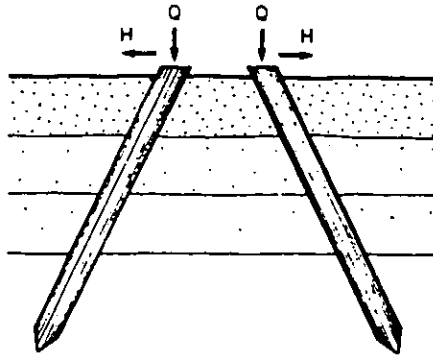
Pilotes inclinados bajo carga horizontal
